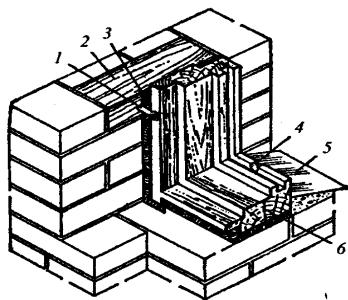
Крепление оконных блоков в проемах каменных стен (переплеты и подоконная доска не показаны):
